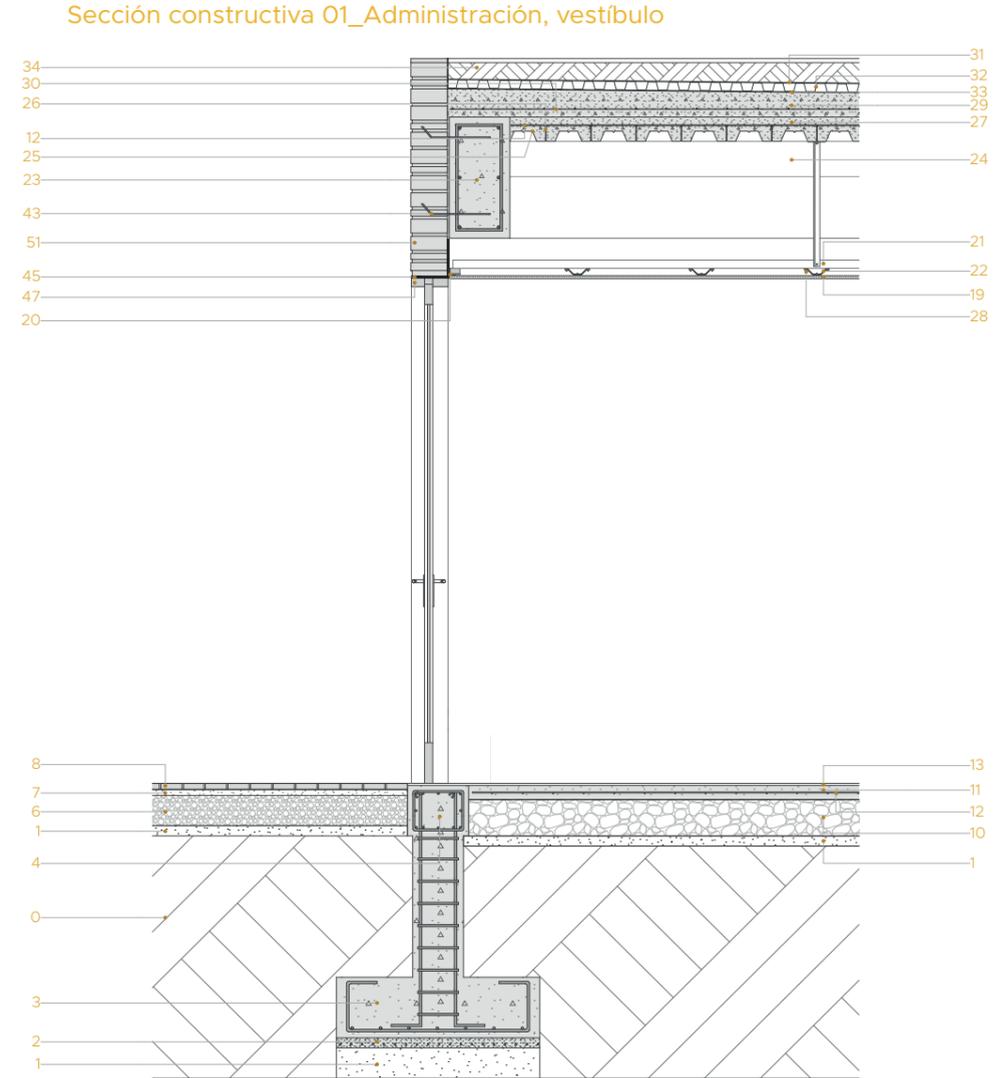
\_C4: sección constructiva\_01, vestíbulo de zona administrativa
